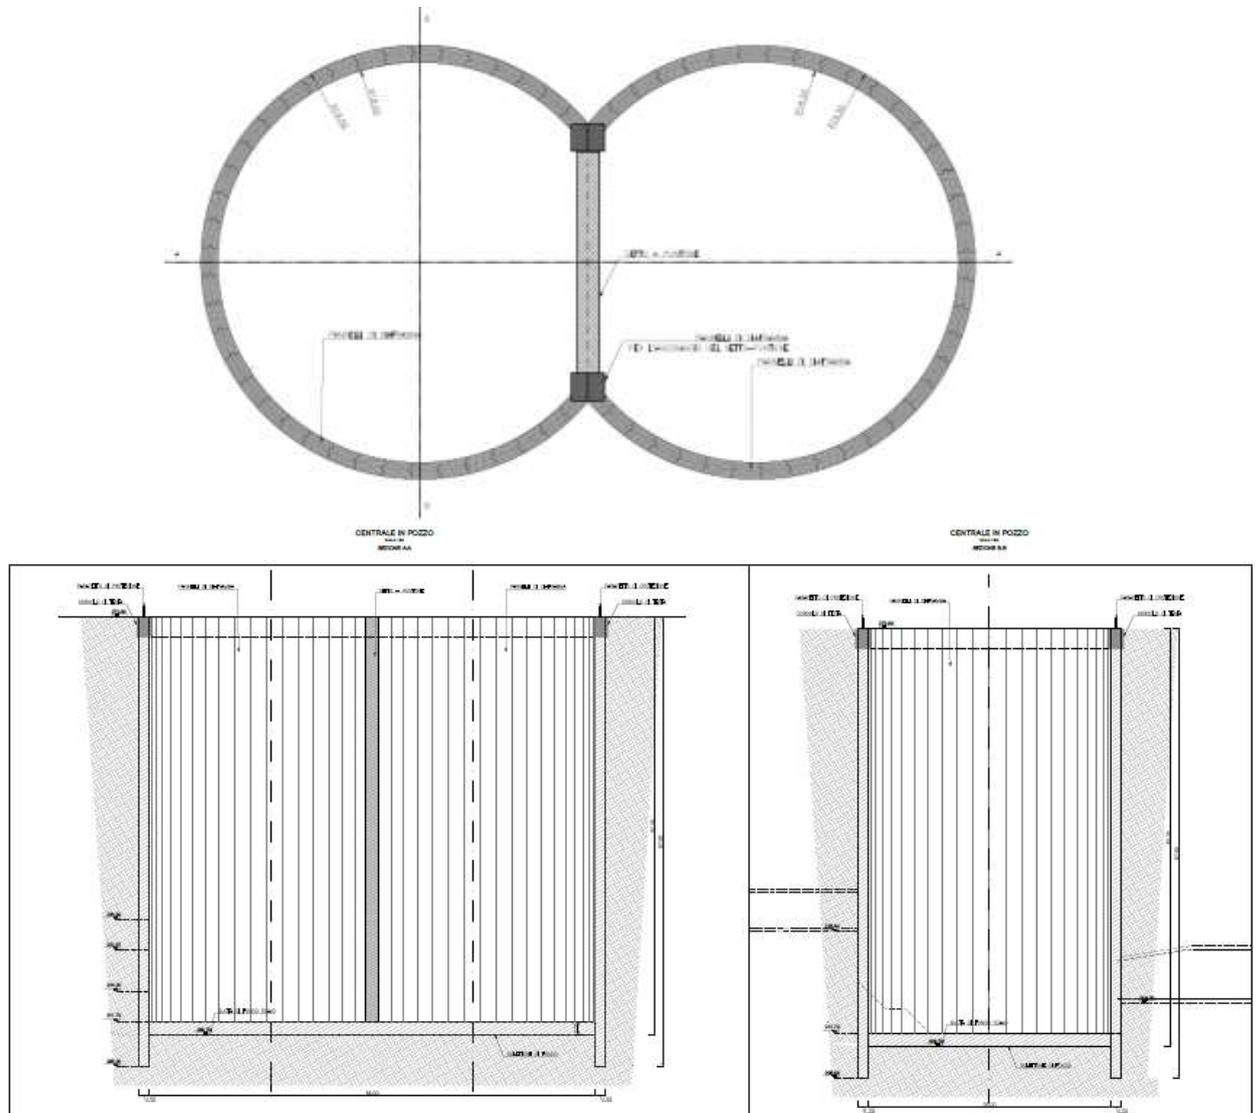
Centrale in pozzo, pianta e sezioni tipologiche
